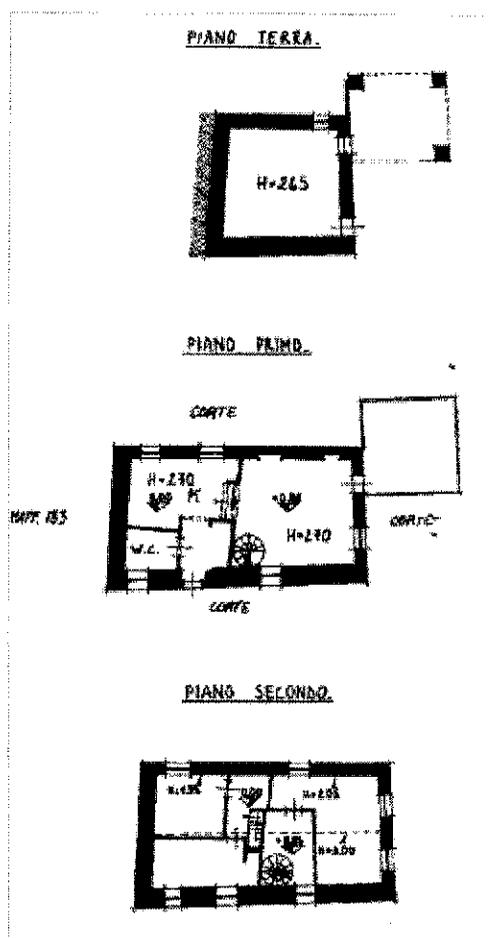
Stralcio Planimetria Catastale agli atti dell'AdE
